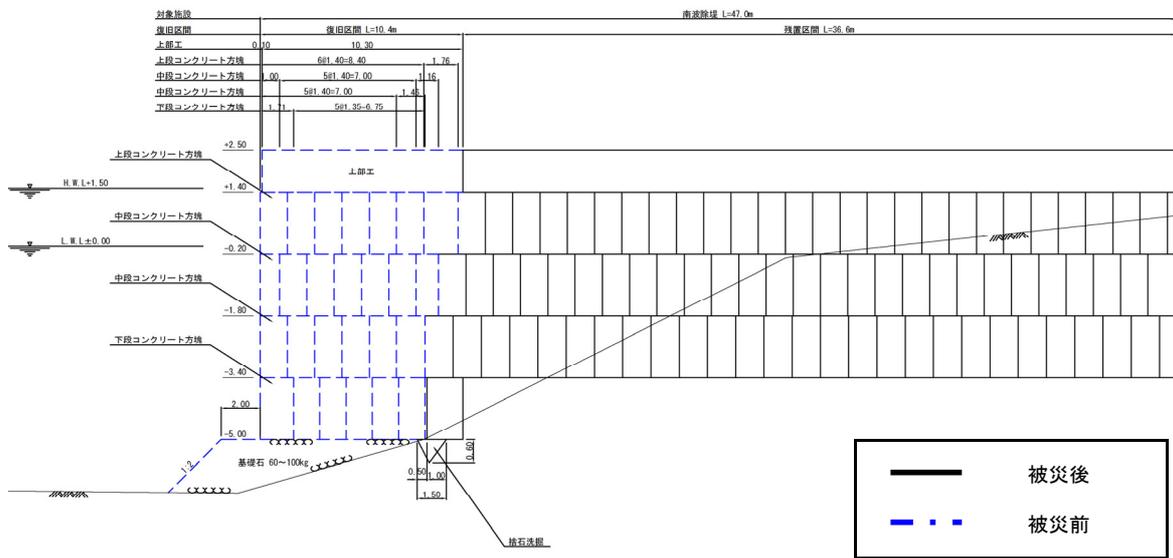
No.6 大洗港区_南波除堤の断面図 (被災後)
